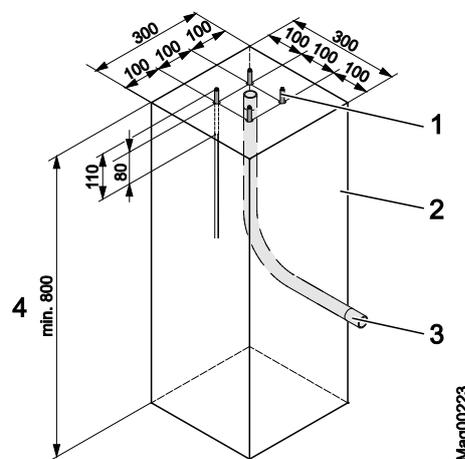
Fundamentplan Auflagepfosten und Lichtschrankenpfosten
